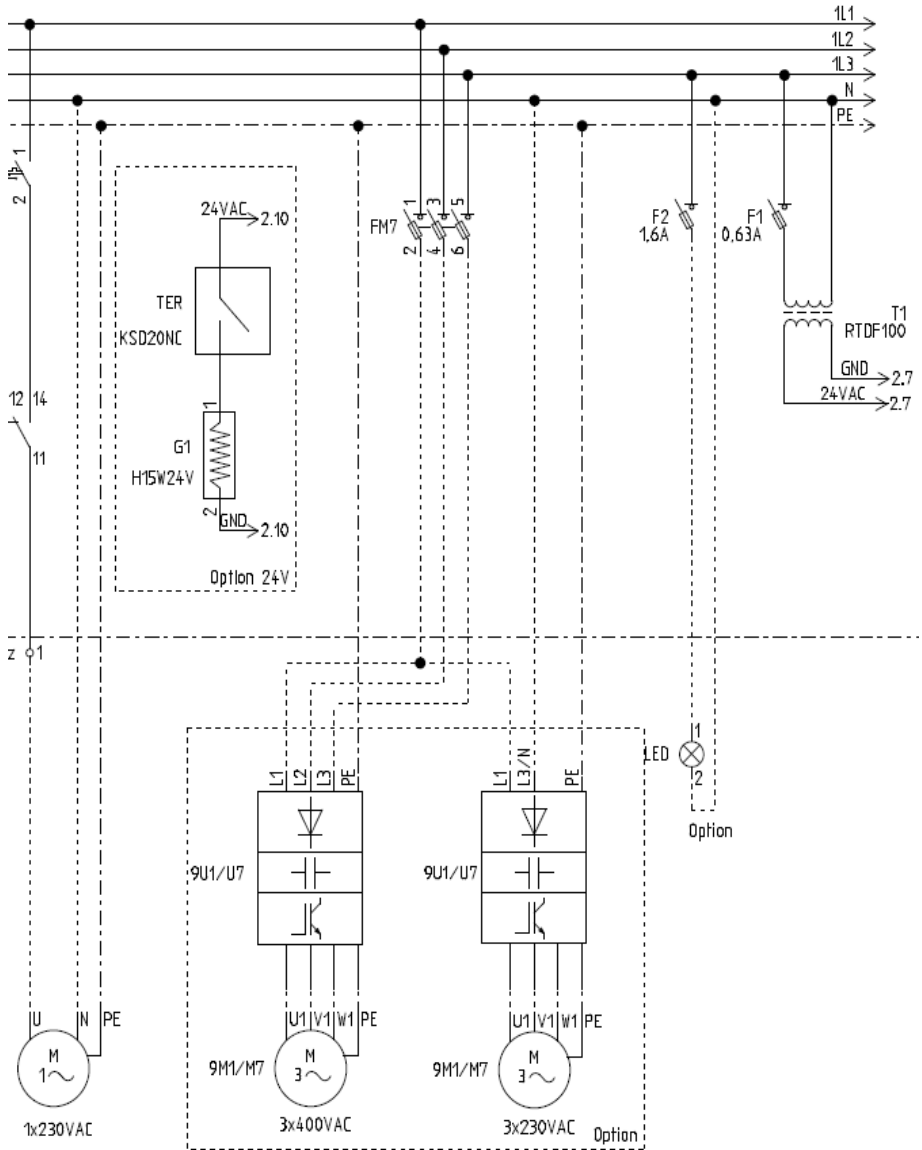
Схема питания для приточно-вытяжных установок – четыре вентилятора 15кВ - (с опцией наружного исполнения).
